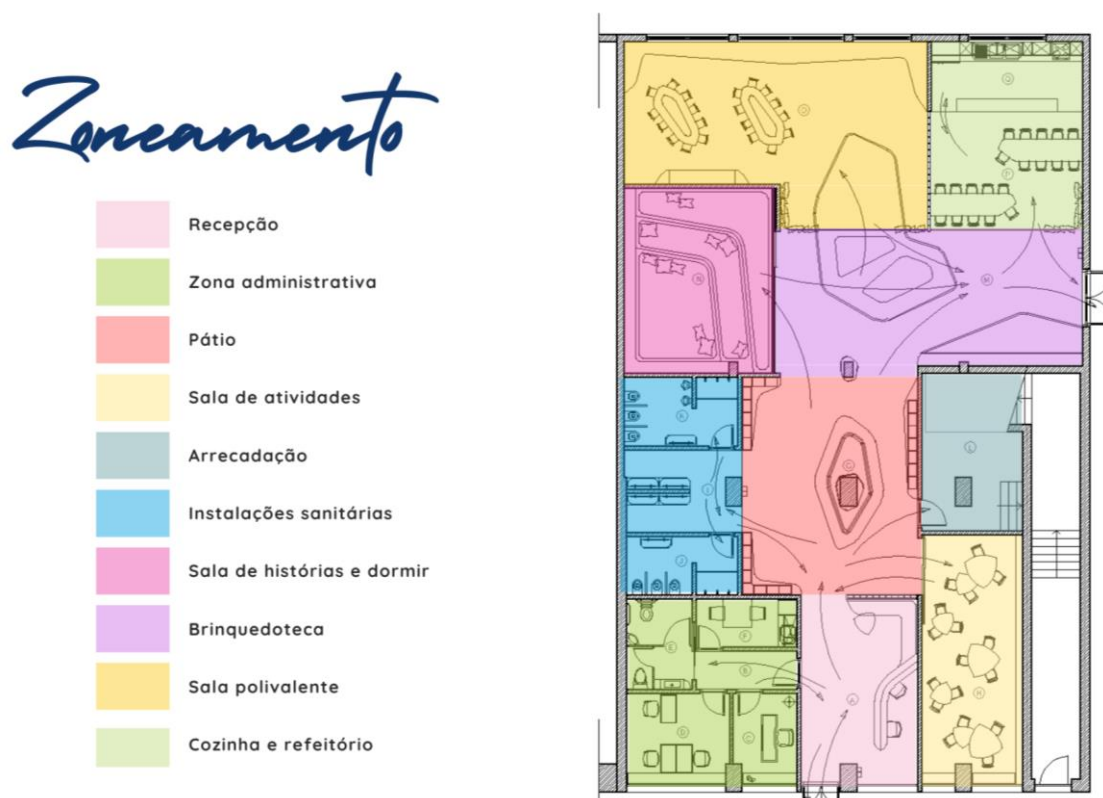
Planta de Zoneamento. Fonte: Augusta Ngonga, 2024.
